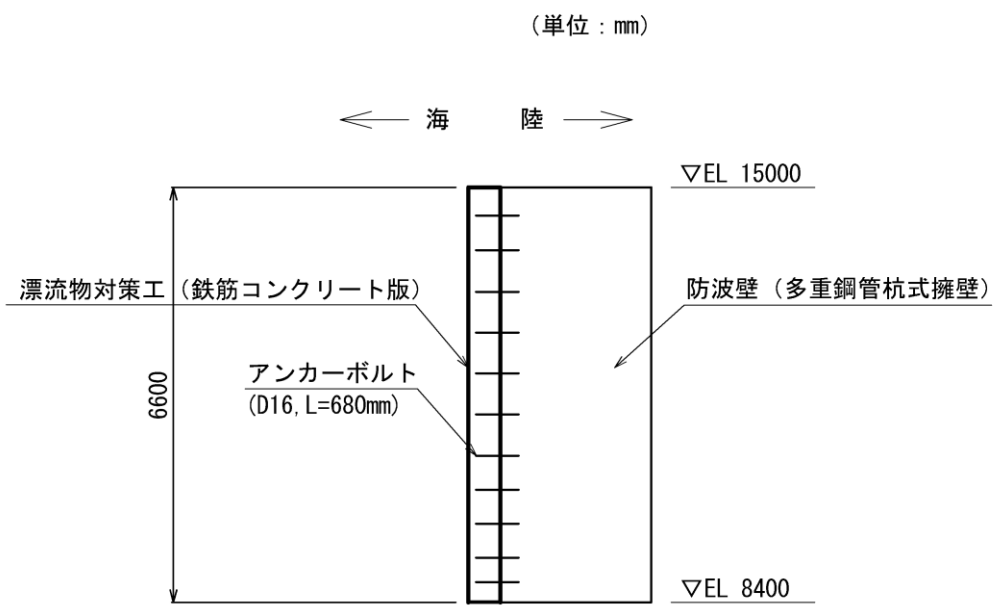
(2) 漂流物対策工 (鉄筋コンクリート版) のアンカーボルト配置図 (断面図)
